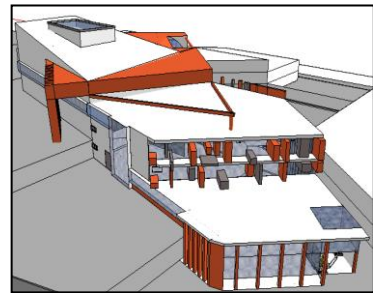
Traitement de la façade ; (Source : auteaures.2020)
